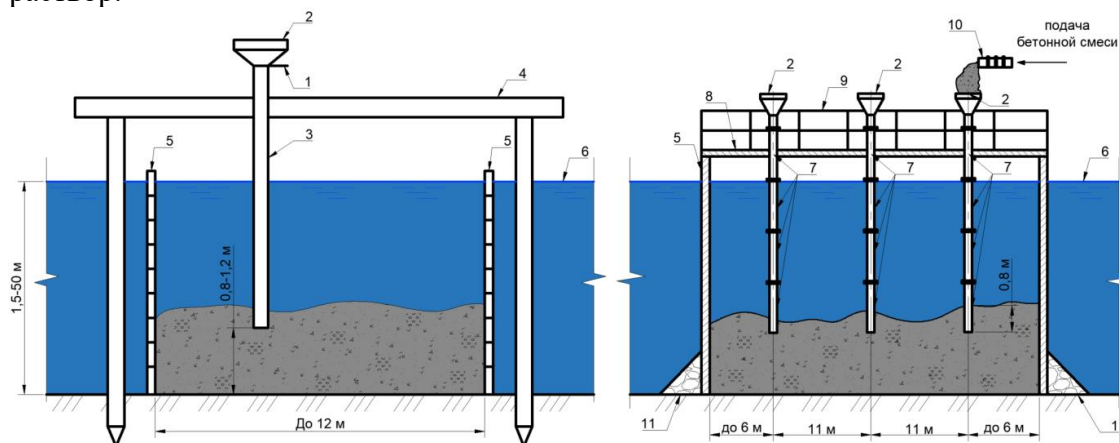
Технологии подводного бетонирования методом вертикально перемещающейся трубы [19]: 1 – затвор воронки; 2 – воронка; 3 – бетонолитная труба; 4 – рабочая эстакада (настил); 5 – опалубка (шпунтовое ограждение) по контуру бетонируемой конструкции; 6 – уровень воды; 7 – звенья труб; 8 – дополнительное крепление опалубки; 9 – ограждение; 10 – бетоновод; 11 – каменно-щебеночная отсыпка
